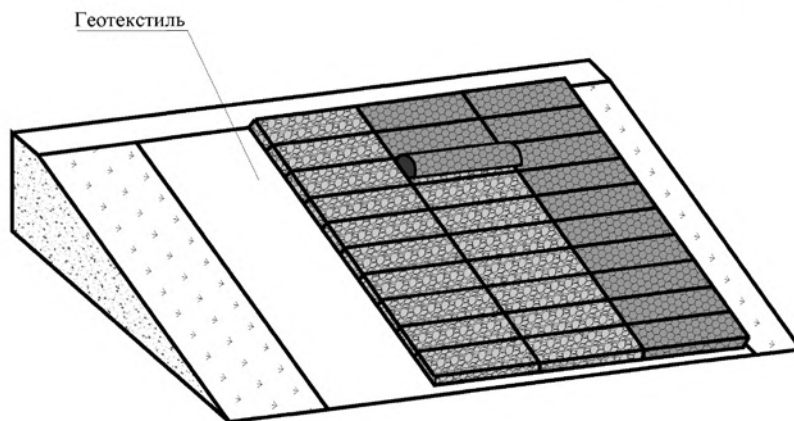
Установка крышки на матрацно-тюфячные габионные конструкции на всю длину укрепления
